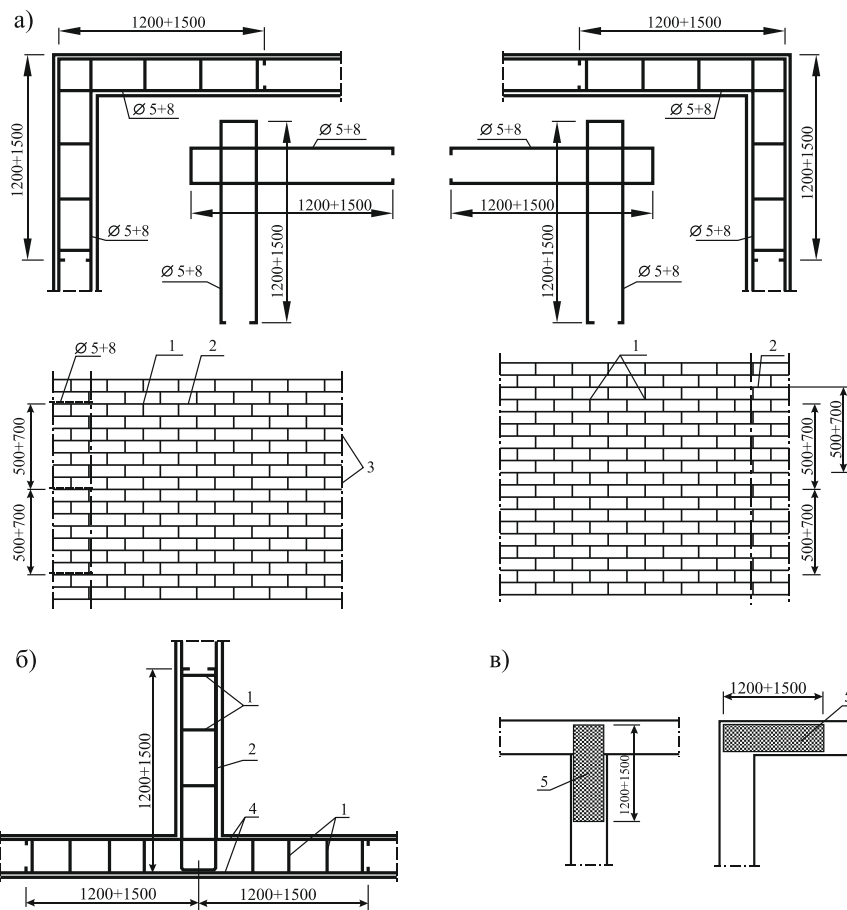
Стыковка по длине горизонтальных растворяемых швов арматурных сеток Murfor (размеры в мм) [34,35,36]
